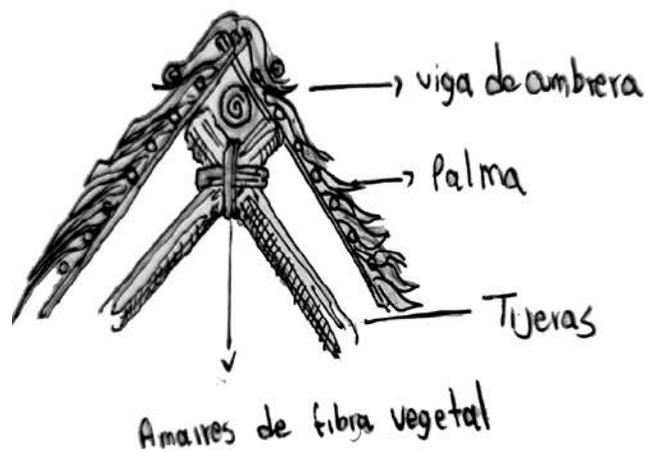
, Dibujo propio realizado en tinta china y lápiz, detalle constructivo de la cubierta de una vivienda Maya tradicional
